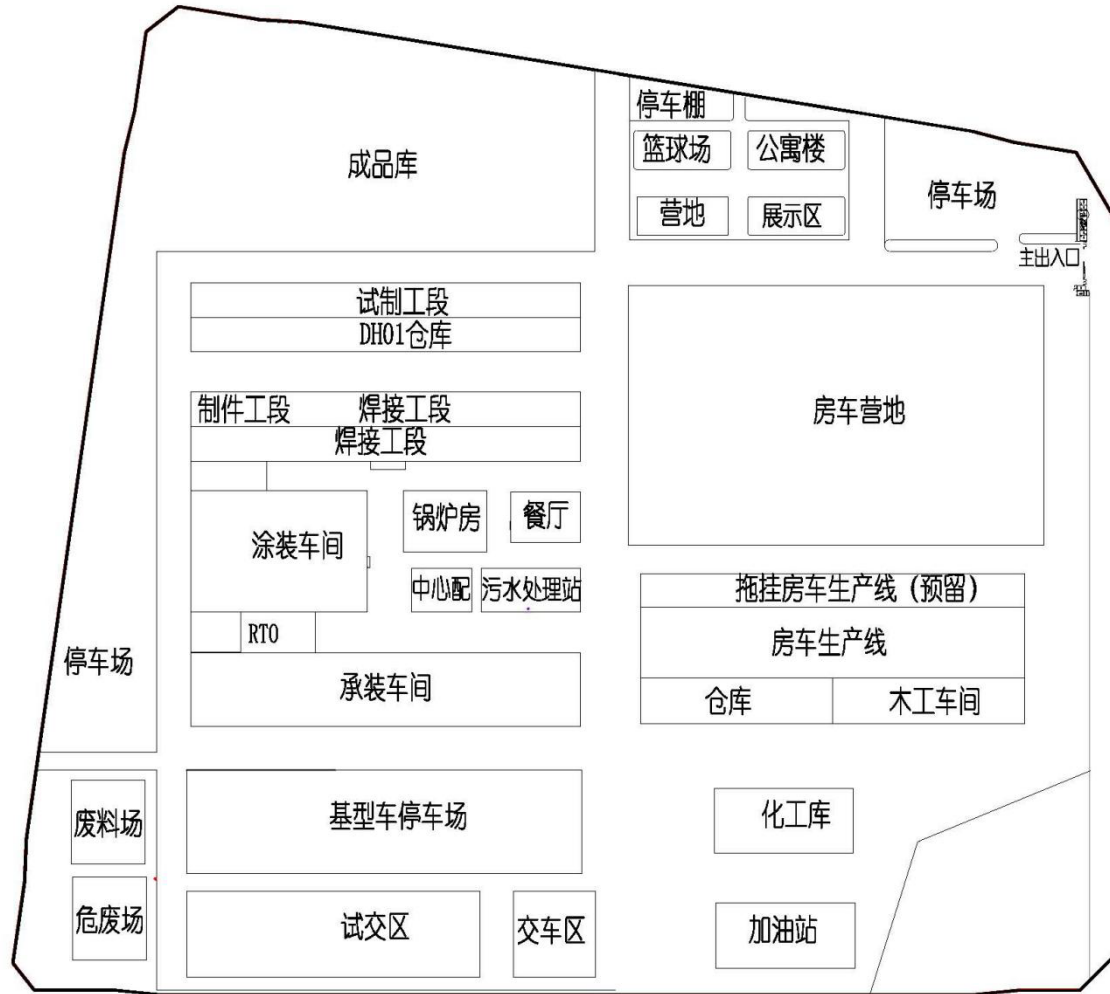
宇通客车股份有限公司专用车分公司厂区平面布置图
